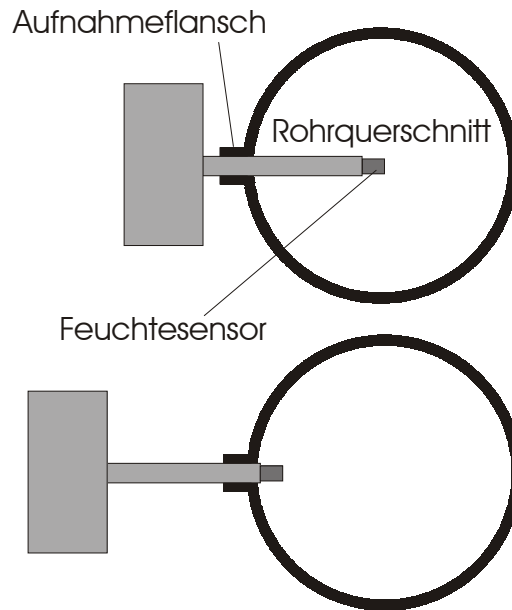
Positionierung des Feuchtesensors im Querschnitt des Ablufkanals
